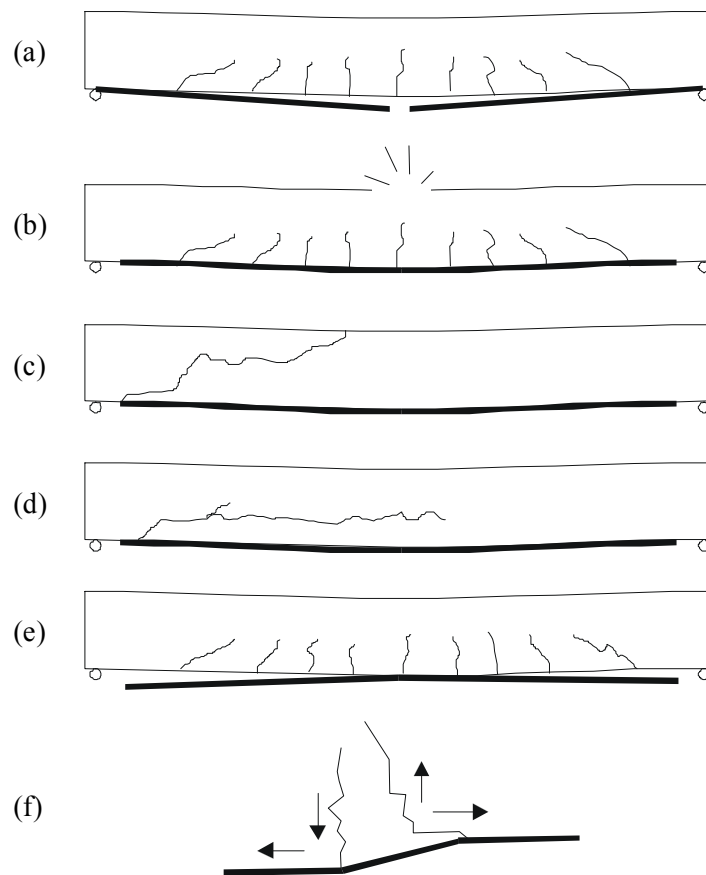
Mecanismos de falla en vigas de hormigón reforzadas con FRP: (a) Plastificación del acero y rotura del FRP; (b) Aplastamiento del hormigón; (c) Falla por cortante; (d) Desprendimiento de la capa de hormigón; (e) Despegue del FRP; (f) Despegue por fisuración. [BUYUKOZTURK & HEARING, 1998].
